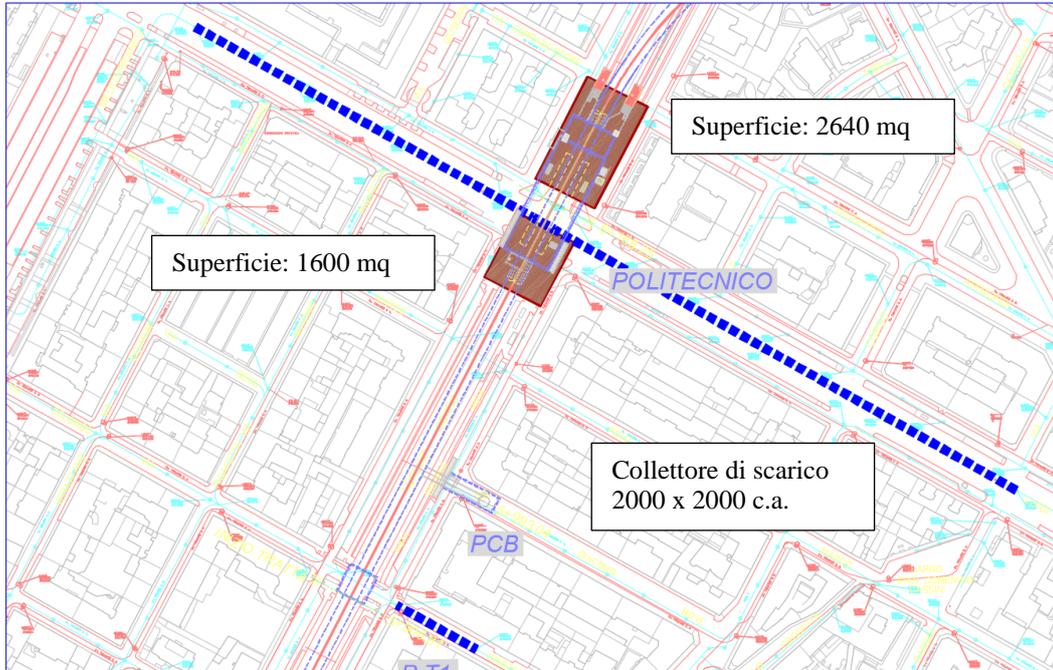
Aree di cantiere – Stazione Politecnico – FASE A
